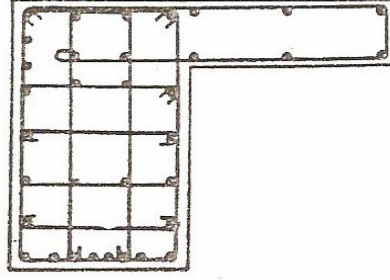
a Boşluğu Çevresinde Tipik Donatı Detayı
